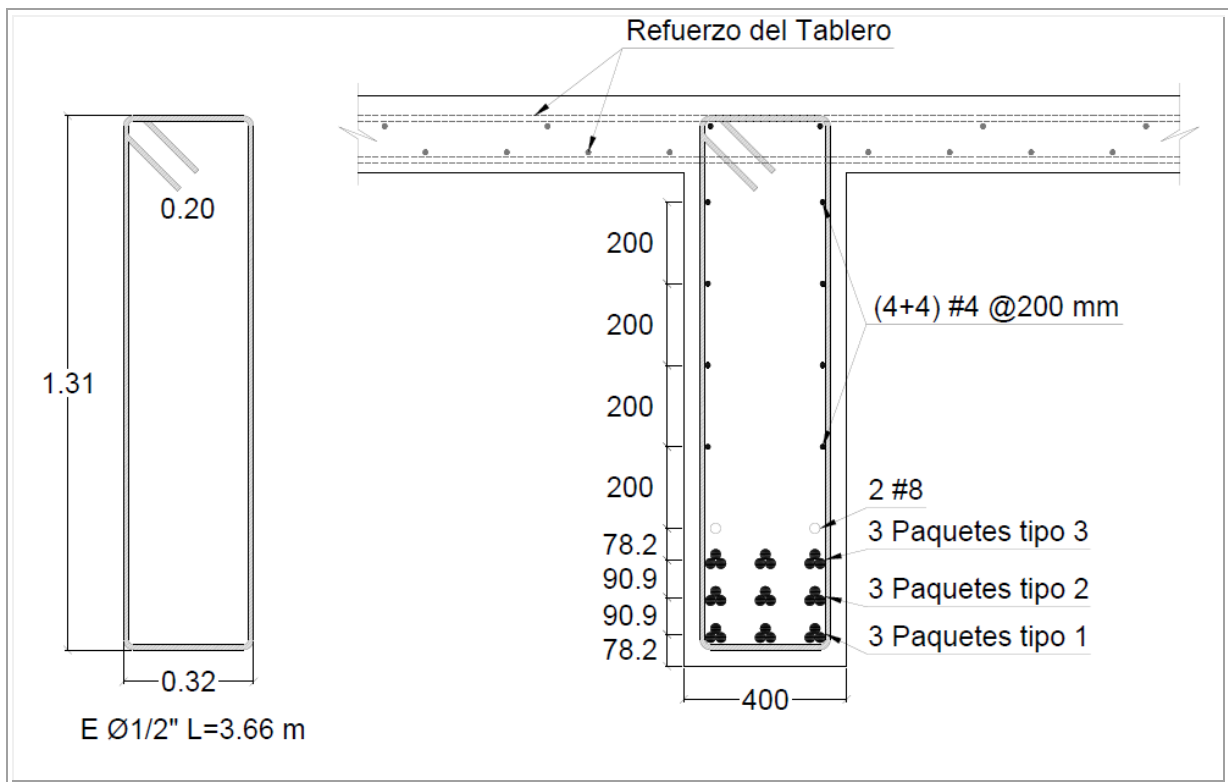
Refuerzo de la viga sección transversal para el centro de la luz
